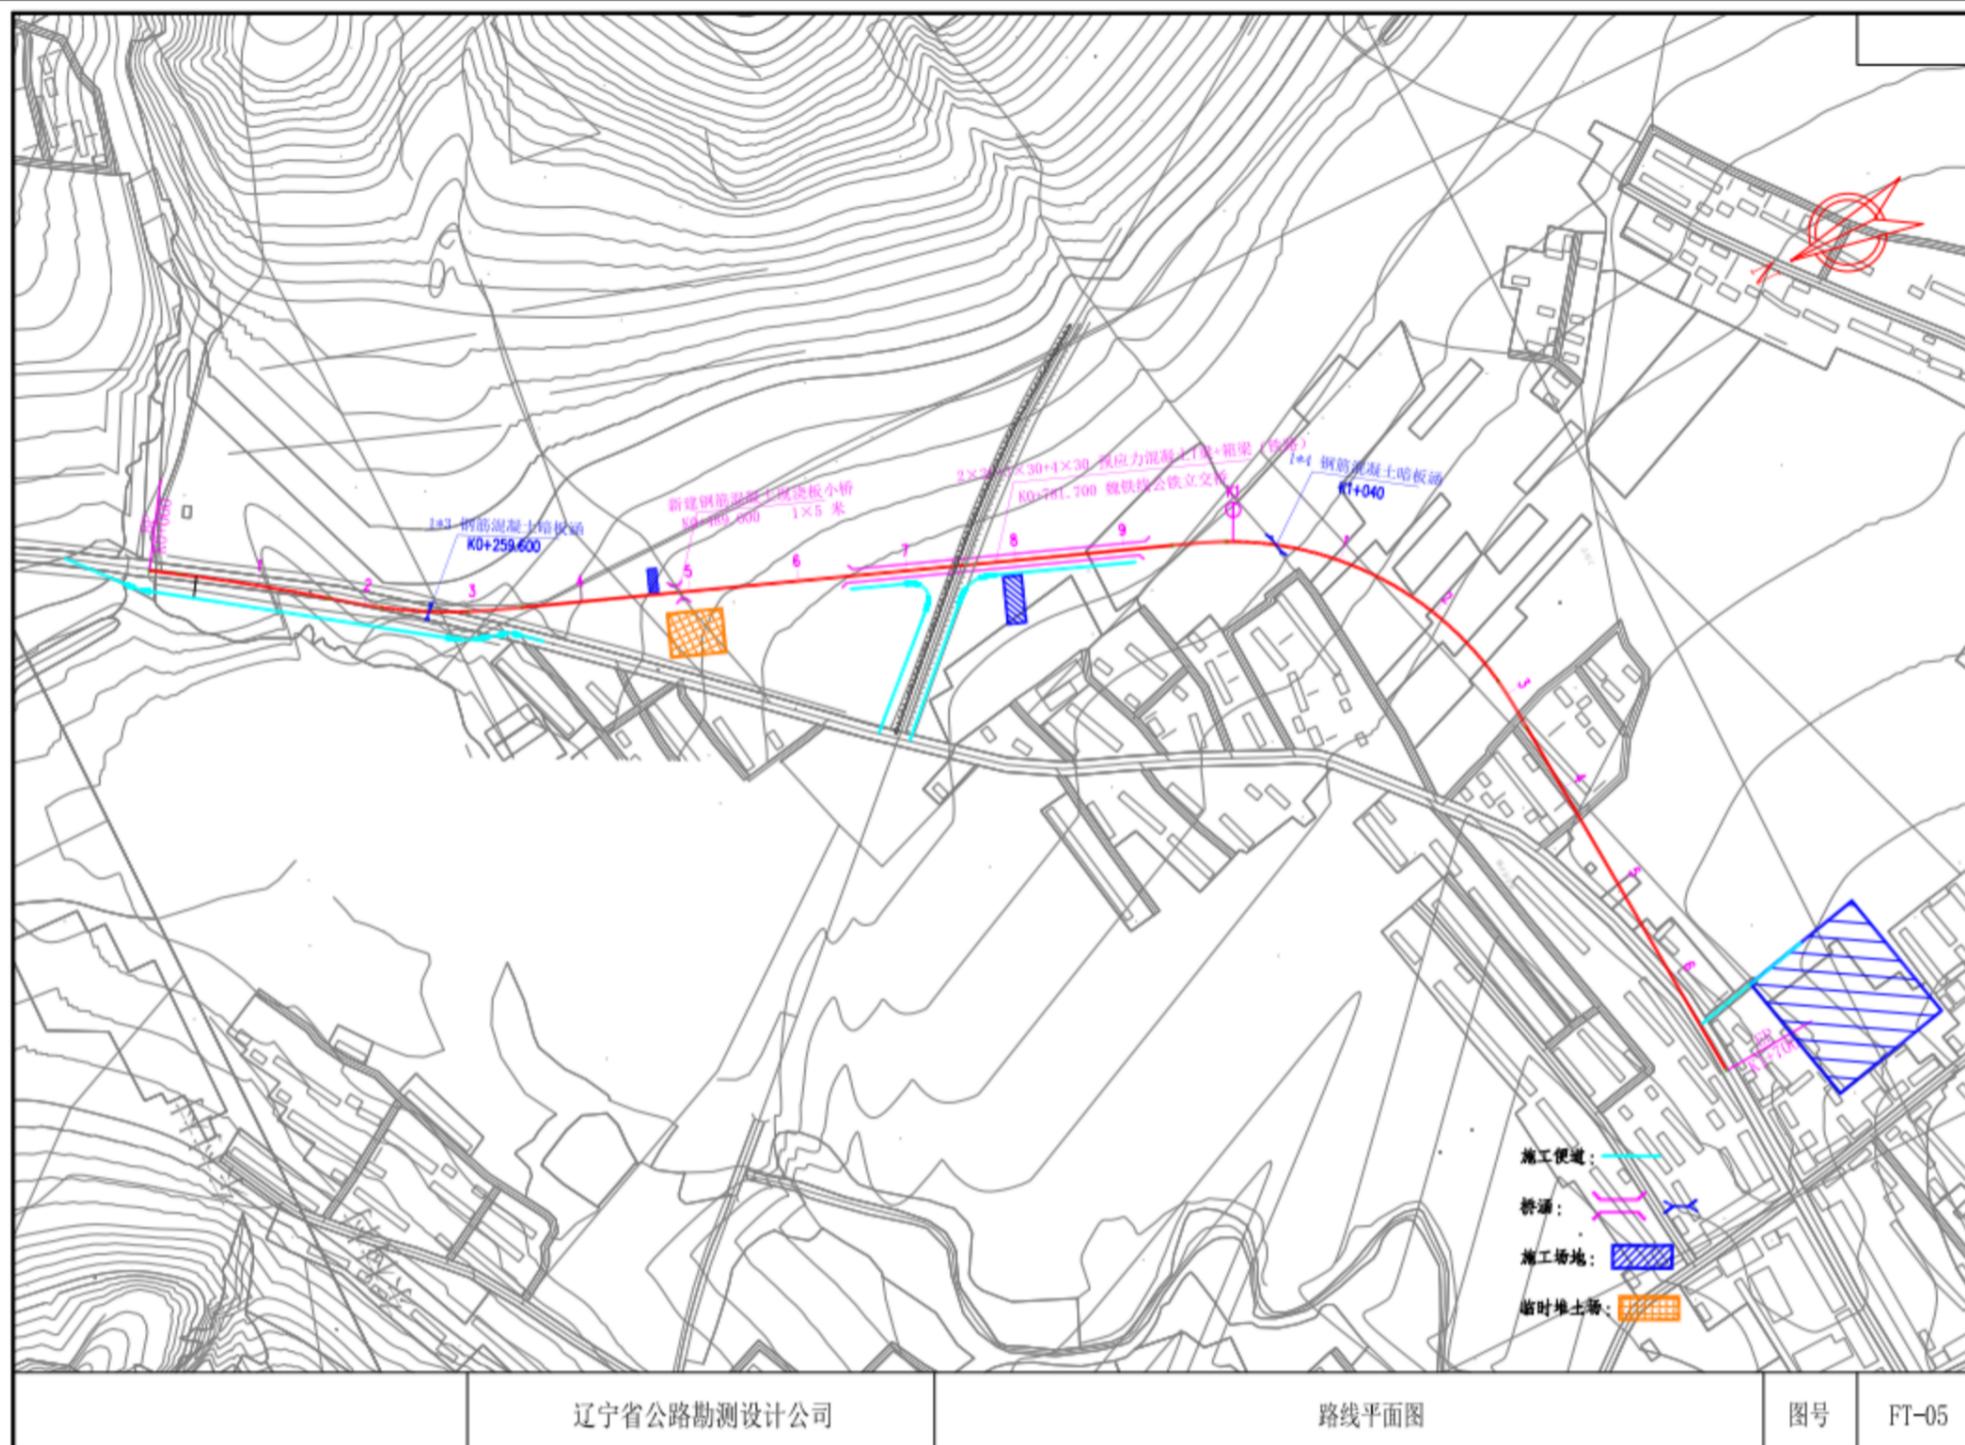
本项目临时工程（施工便道、施工场地、临时堆土场）位置图
